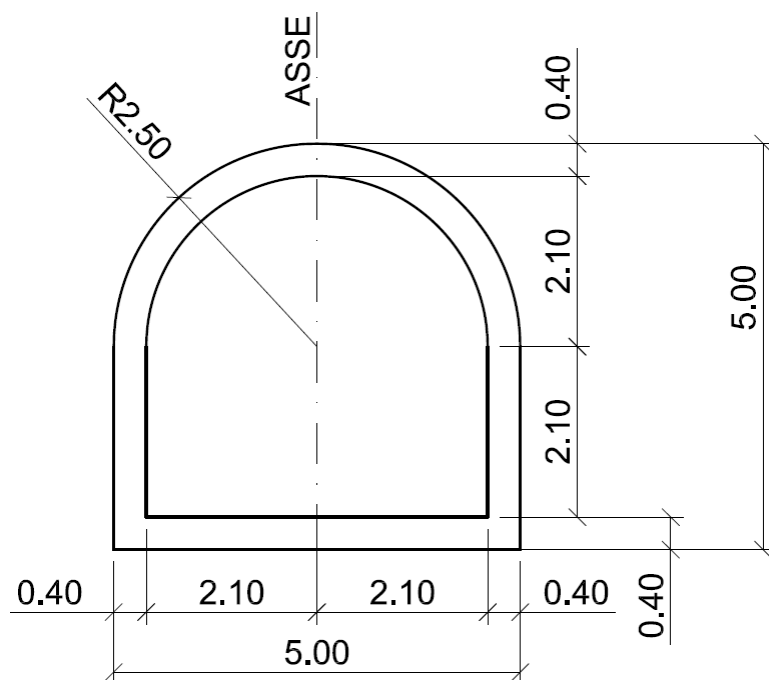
Sezione Analizzata Tipo 3 Galleria Di Accesso Centrale E Pozzo Piezometrico Di Valle
